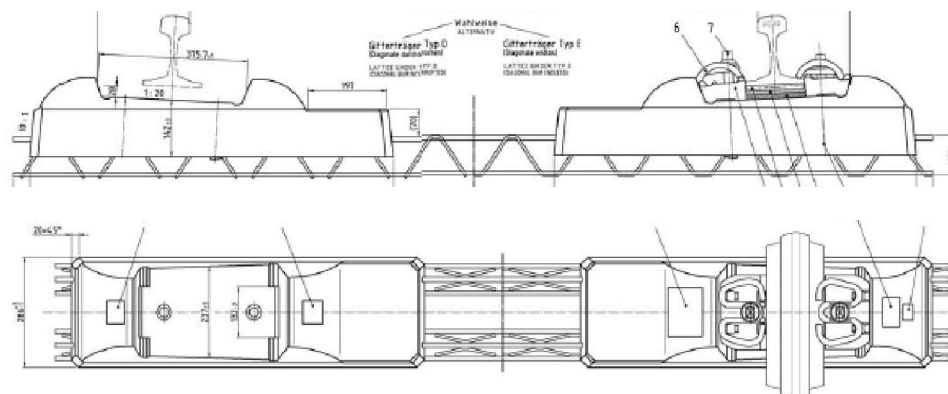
Alçat i planta de la travessa B-355, extret de [10].
